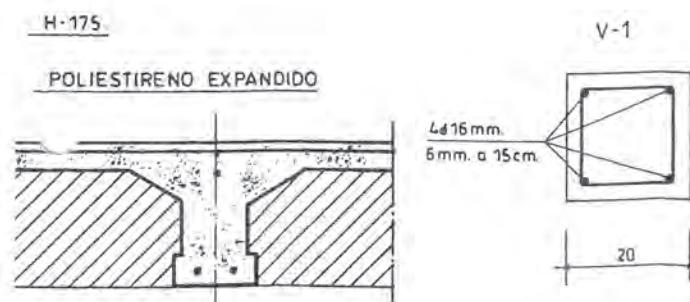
22. 1997 DETALLE CONSTRUCTIVO DE FORJADO Y PILAR
